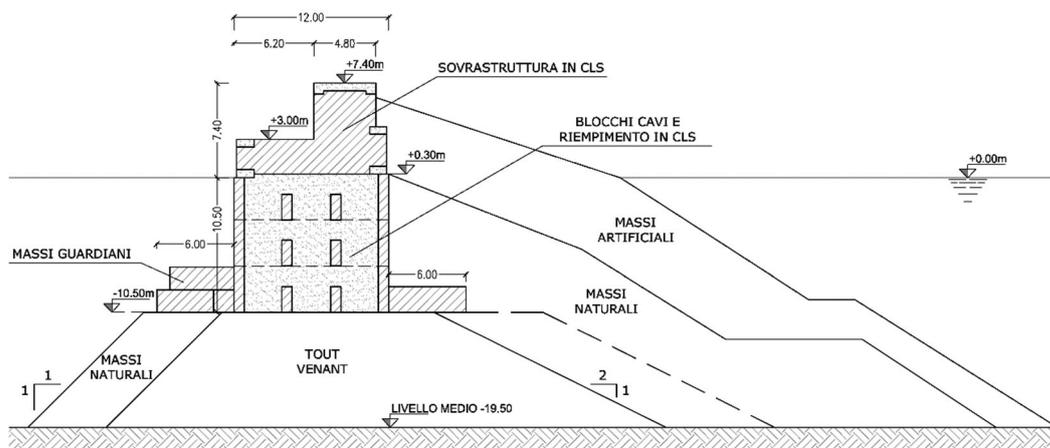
SEZIONE TIPO TRATTO CENTRALE DELLA DIGA ESISTENTE. TRATTO D-E
